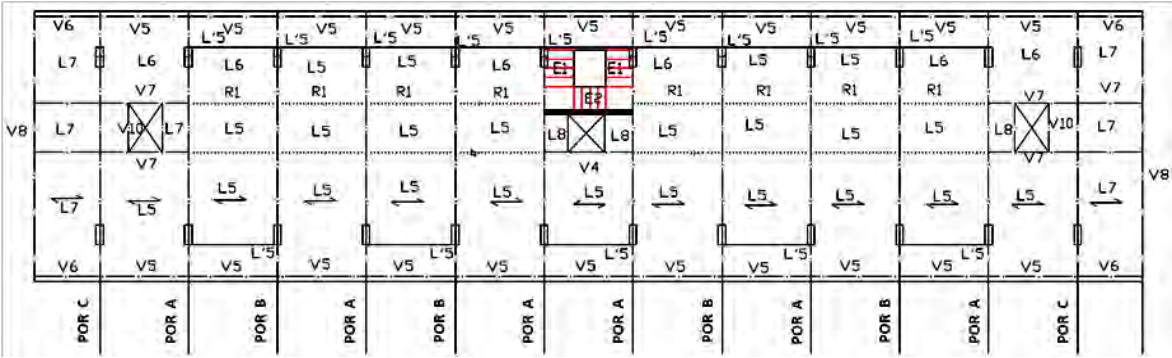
Planta estrutural dos pisos 1, 3, 5 e 7.
